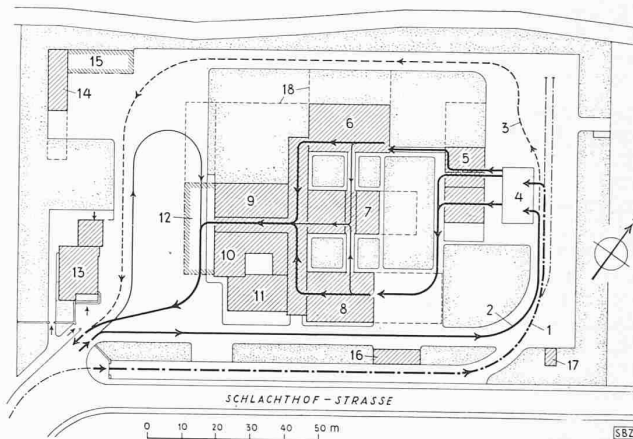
Lageplan der Schlachthofanlage. Masstab 1:2000
